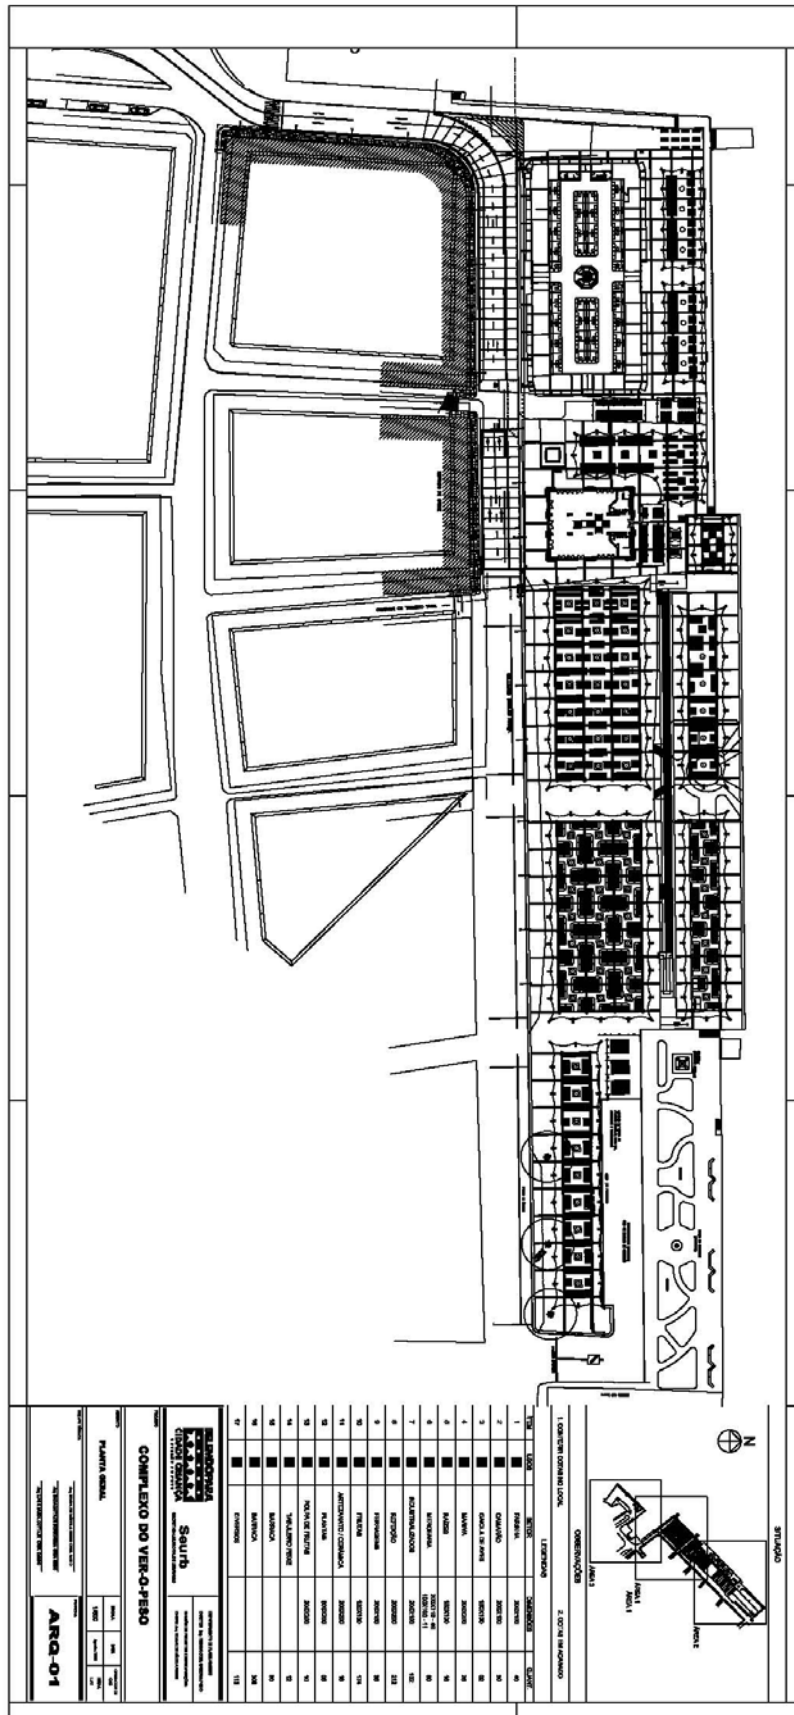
Planta Baixa Geral Projeto Ver-O-Peso. Fonte: P. M. De Belém.
